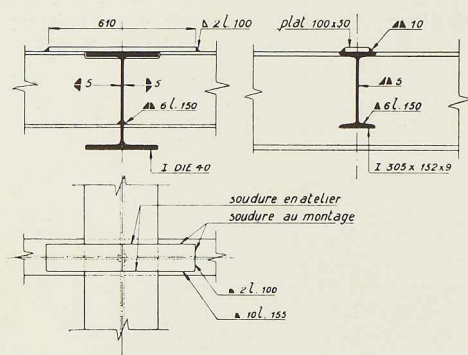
Détail d'assemblage des solives aux poutres principales. Cet assemblage assure la continuité des solives.
